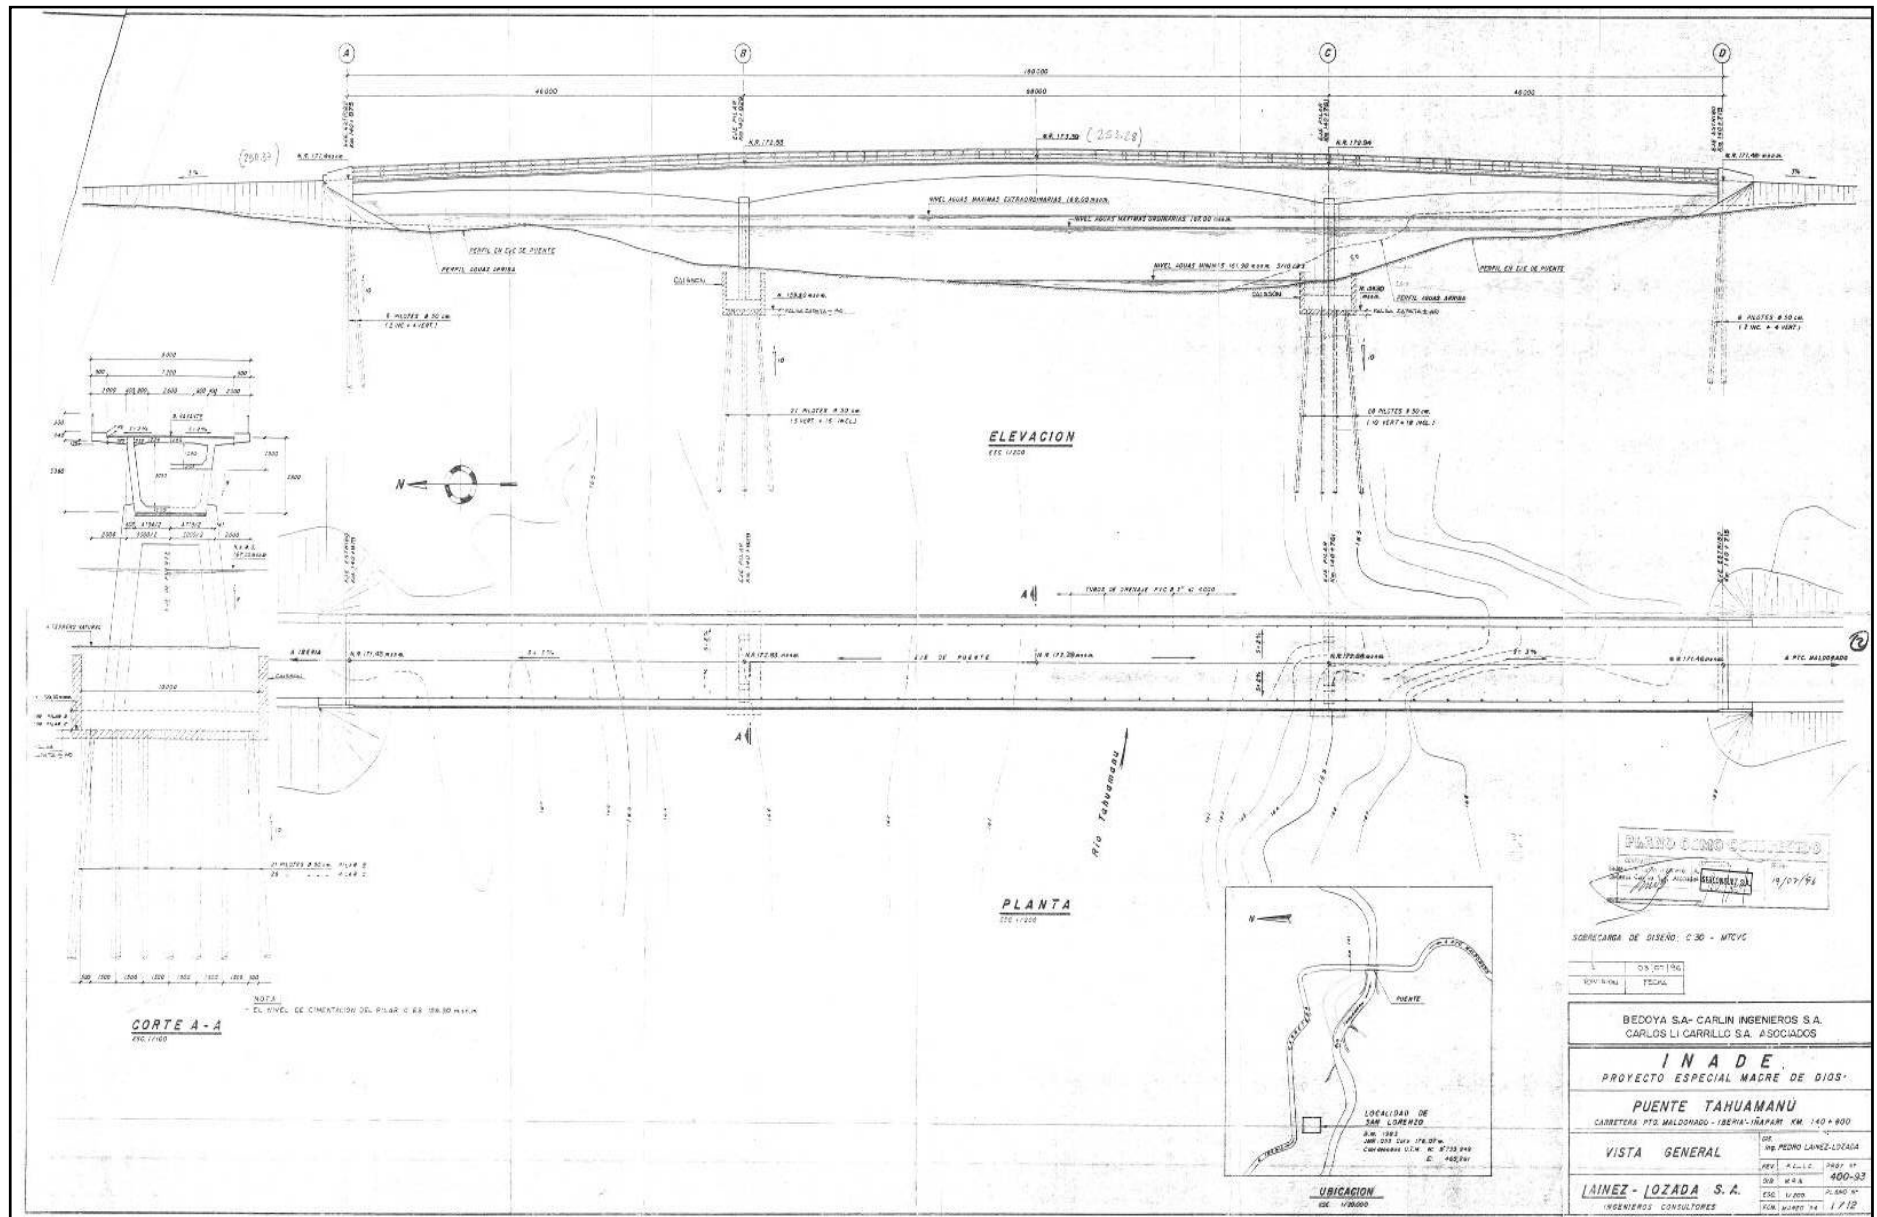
Plano de Planta y Perfil del Puente Tahuamanu (Fuente: INADE – Proyecto Especial Madre de Dios)
